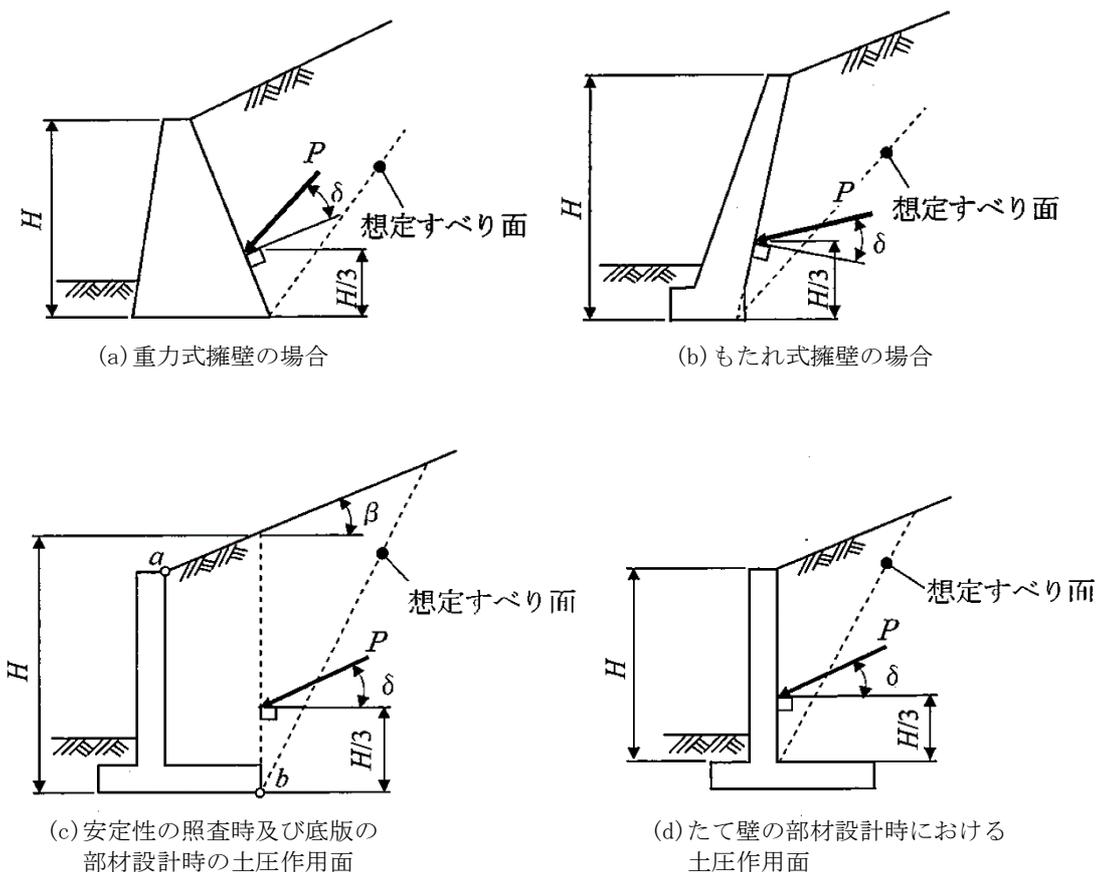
土圧の作用面と内部摩擦角⁸⁾
